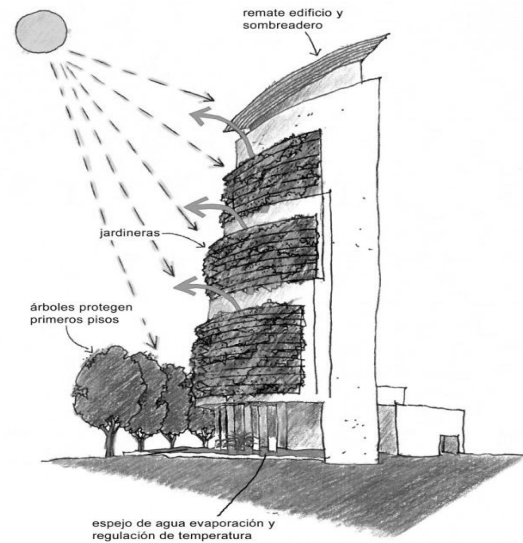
Medidas de protección a considerar para el edificio. Fuente: Tomado desde <https://www.flickr.com>
